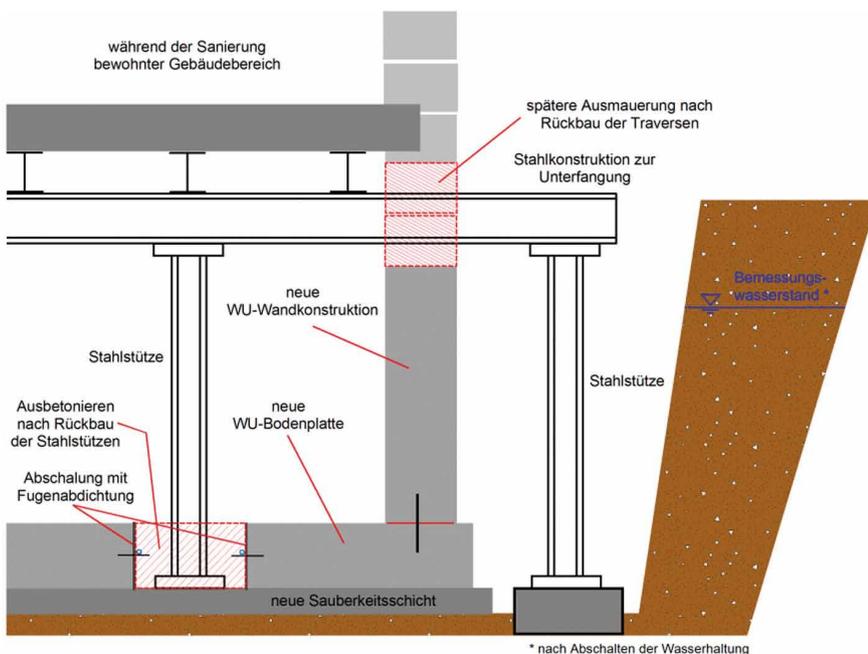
Einbau einer weißen Wanne unter ein bestehendes Bauwerk nach abschnittweisem Rückbau des alten Mauerwerkskellers
